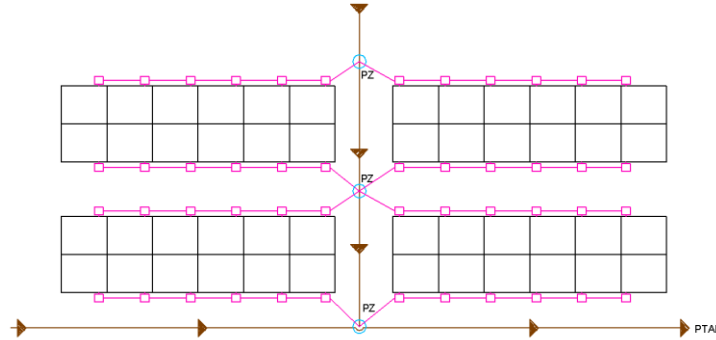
Esquema de red de Alcantarillado Sanitario con ramales
